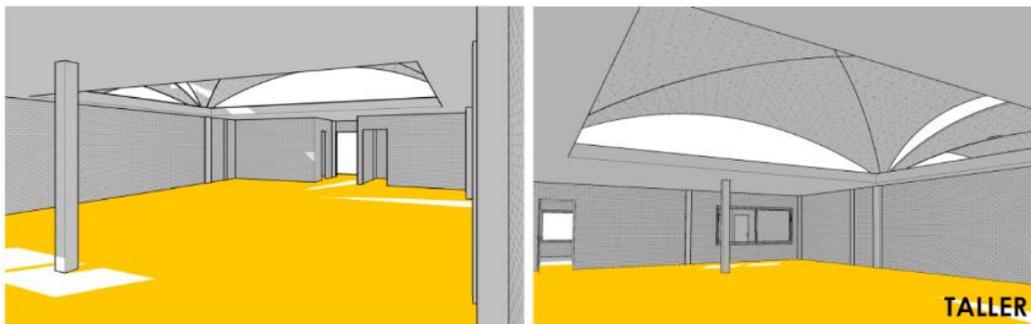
Arquitectura Moderna Tecnologías constructivas. Modelado BIM.
